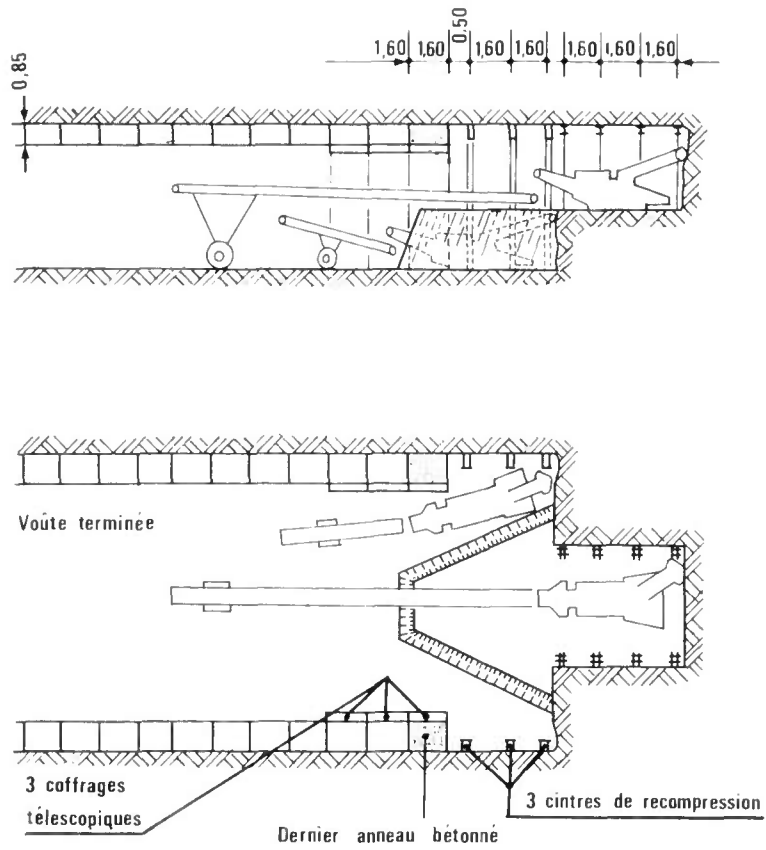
Autoroute A 13 - Tunnel de St-Cloud. Bétonnage à l'avancement en demi-section supérieure.
